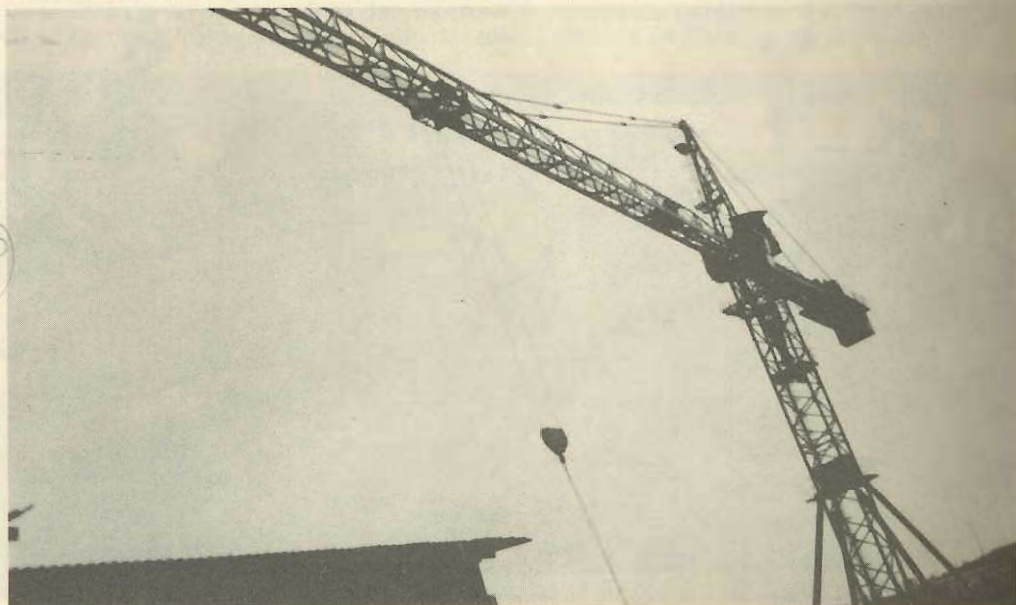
Guindaste tipo lança em torre, para manuseio de barras beneficiadas - Itaipu
